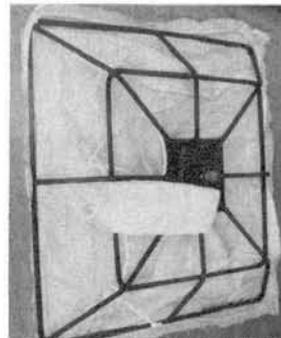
角錐台型布型枠 写真-4 ラス鋼フレーム布型枠
